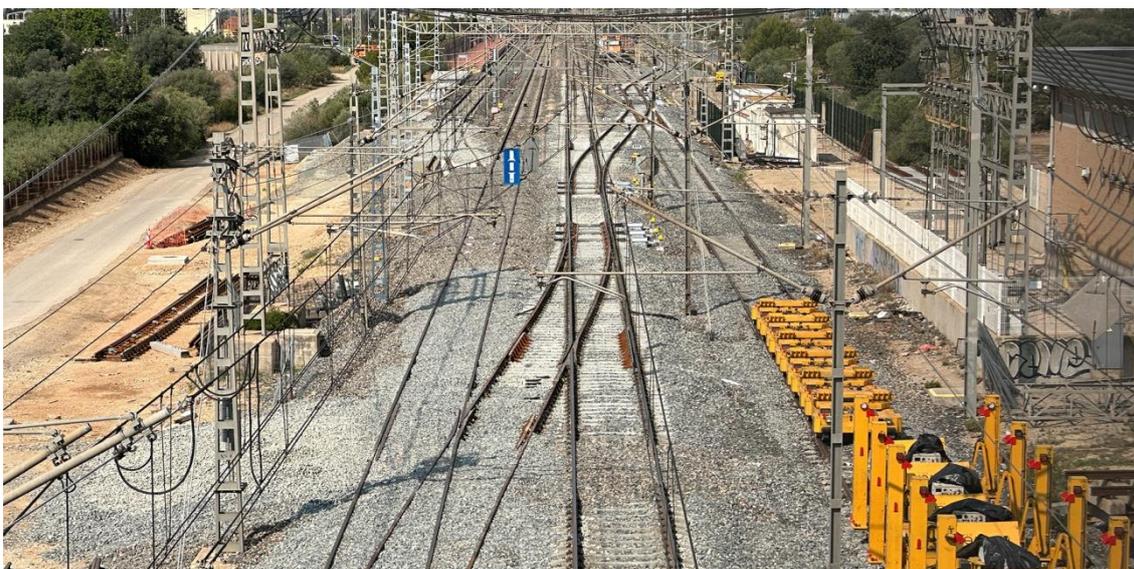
Obras de implantación de ancho estándar de vía. Vinaroz – Vandellós.
